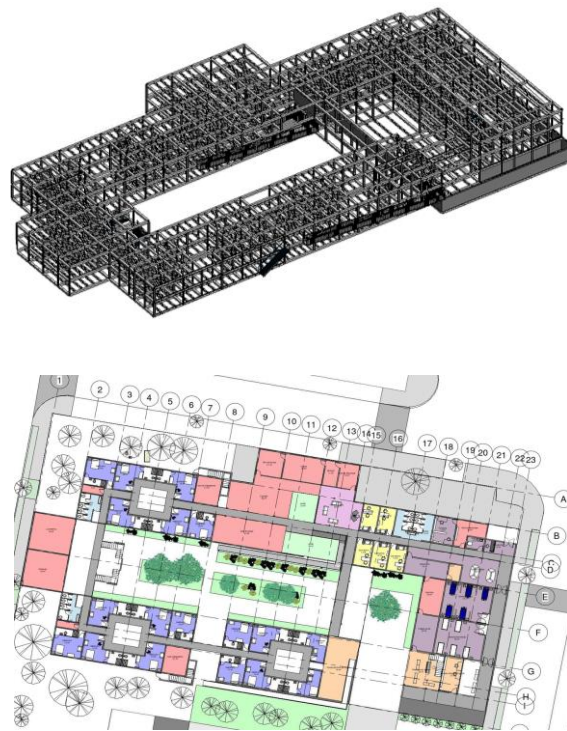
y 9: Estructura y áreas de primer nivel del proyecto
